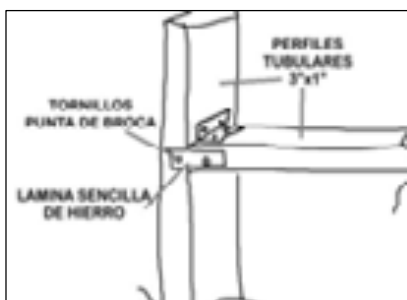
Croquis elementos de fijación para paredes internas
